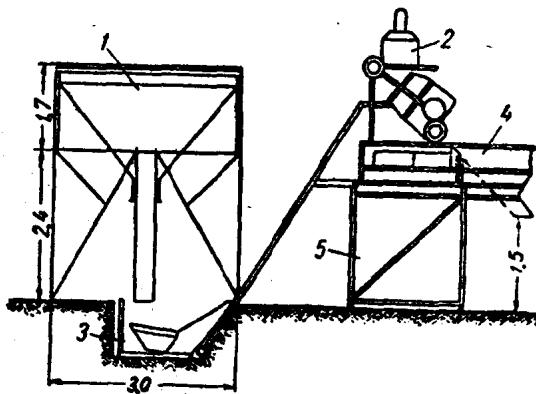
混凝土攪拌機設在台上時，調制混凝土混合料的圖式方案
